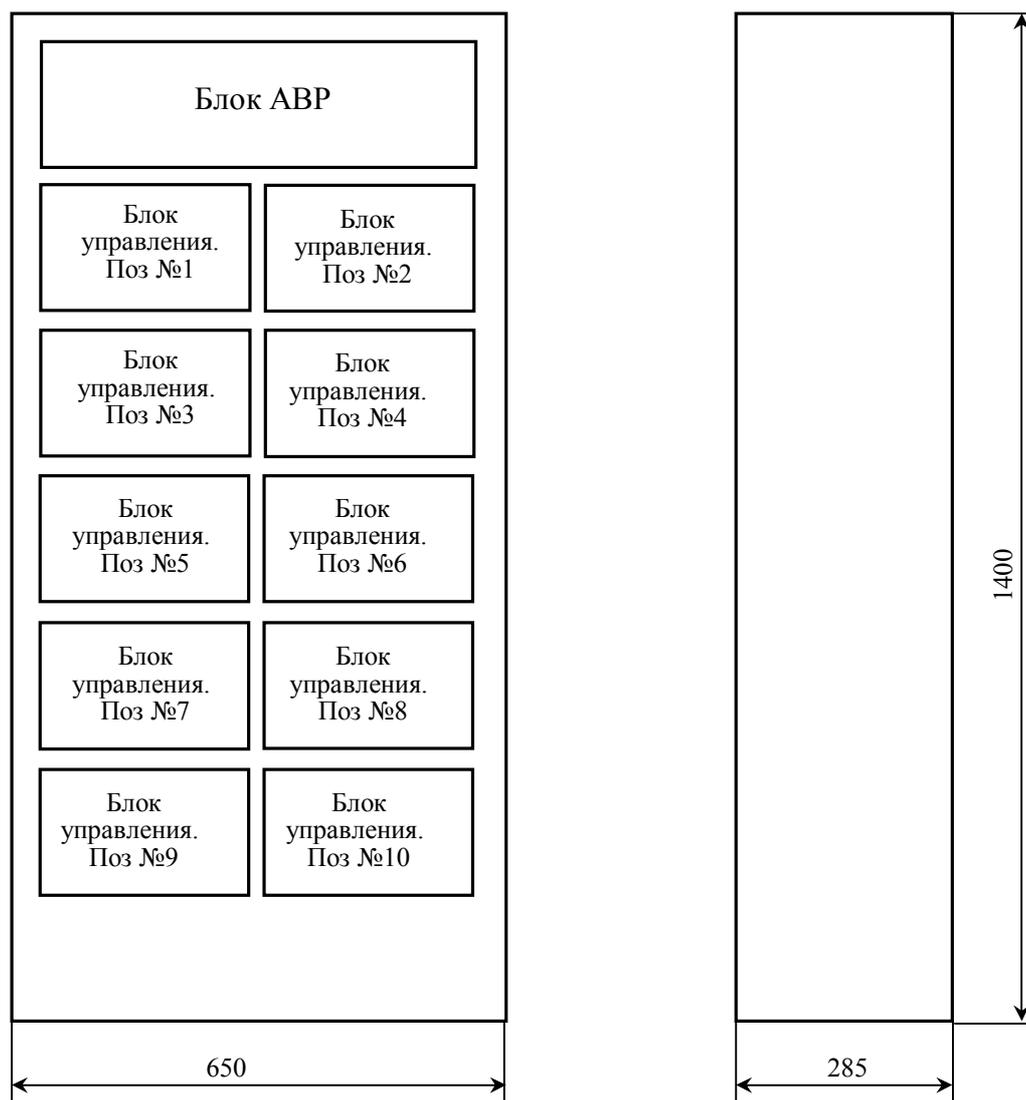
Габаритные и установочные размеры шкафа ШУЭ-10.
